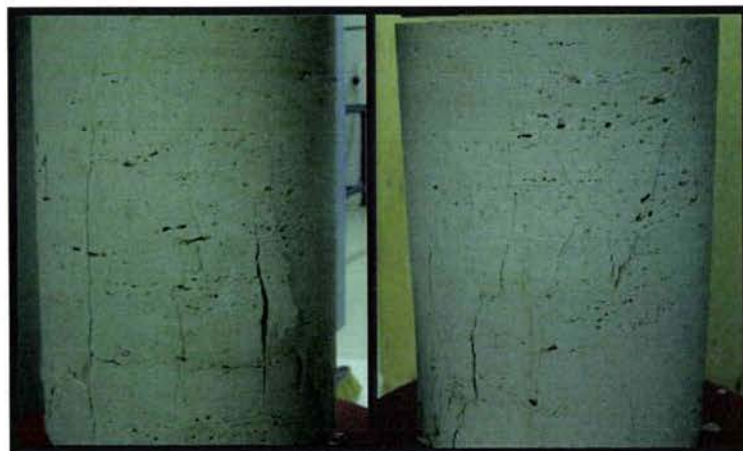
Fissuration partielle et écaillage des échantillons II-C1 à gauche, II-A1 à droite, on note que la fissuration apparaît suite à la mise en tonneau.
